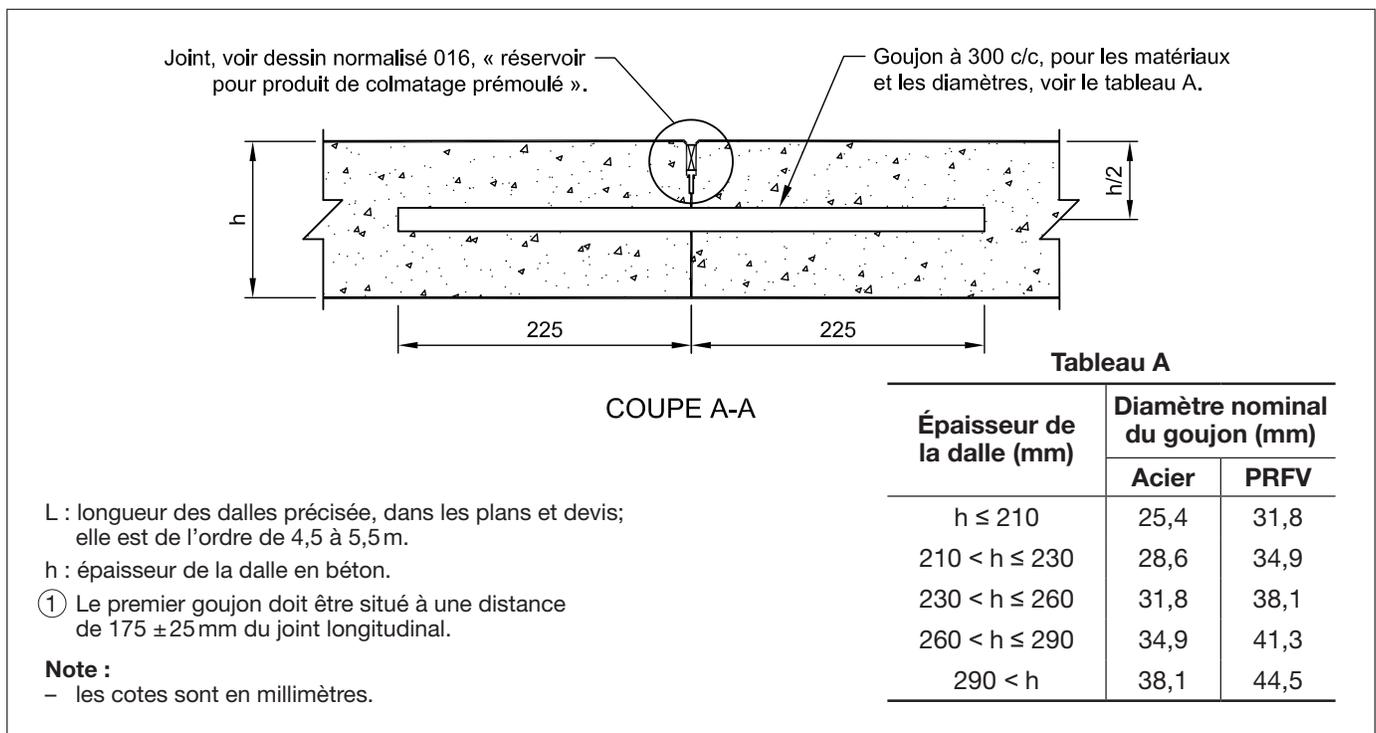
Extrait du DN II-2-019 « Structure de chaussée rigide – Dalles courtes goujonnées, joint transversal »
